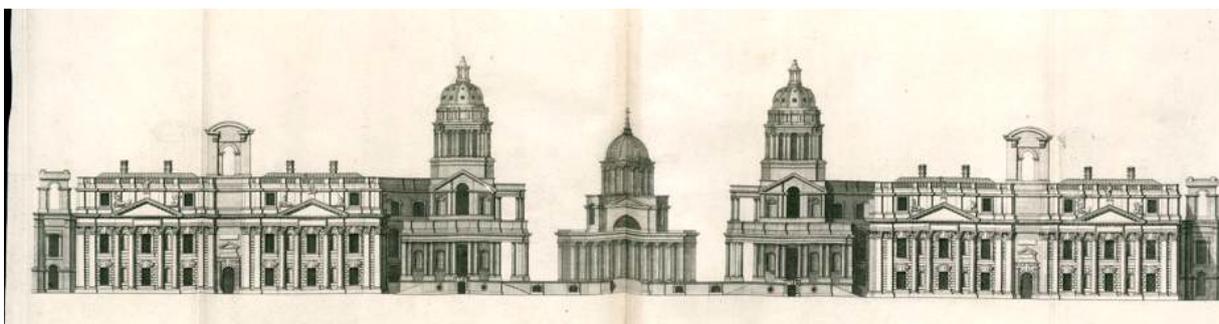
Henry Hulsbergh, *Prospetto fluviale dell'ospedale reale navale di Greenwich con progetto per una chiesa a pianta centrale in asse con la Queen's House* (da Campbell 1714)
